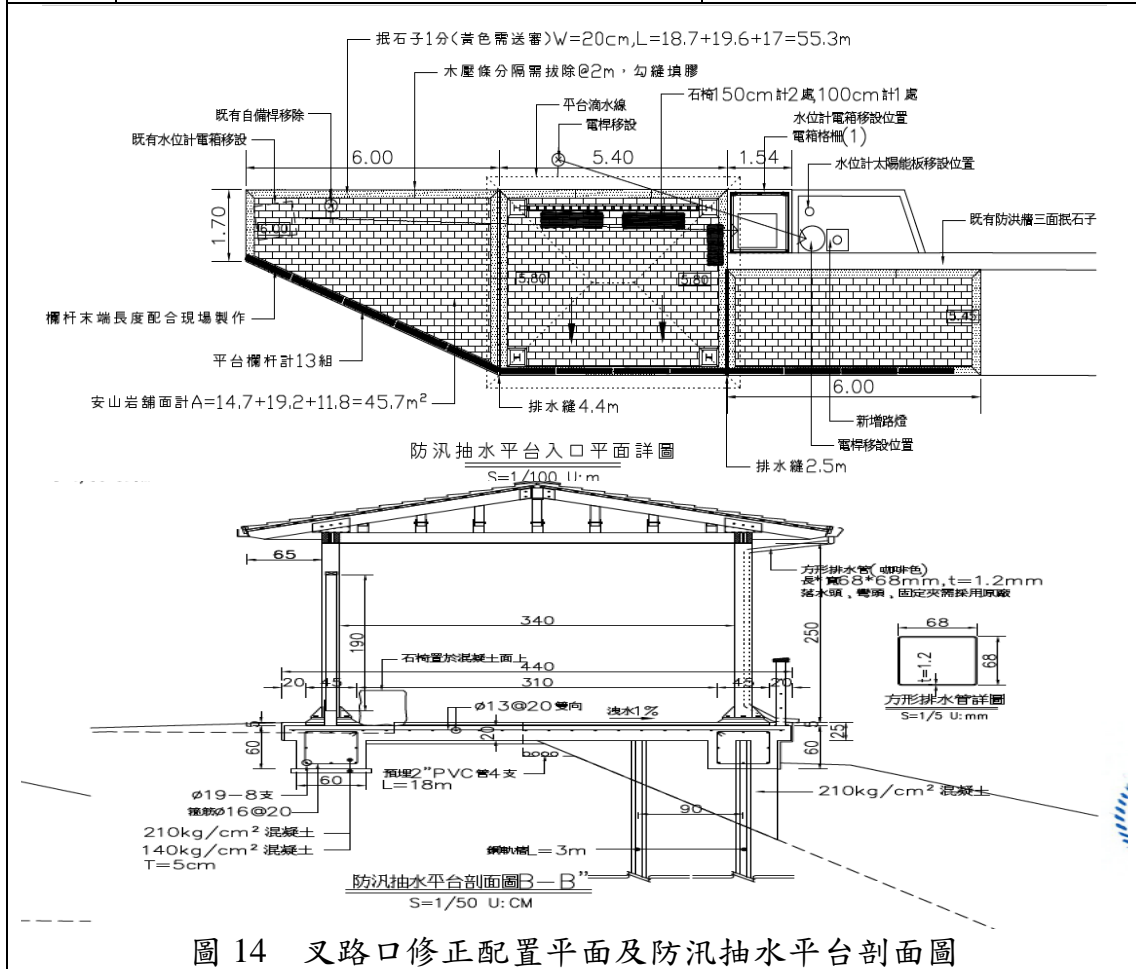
叉路口修正配置平面及防汛抽水平台剖面圖
